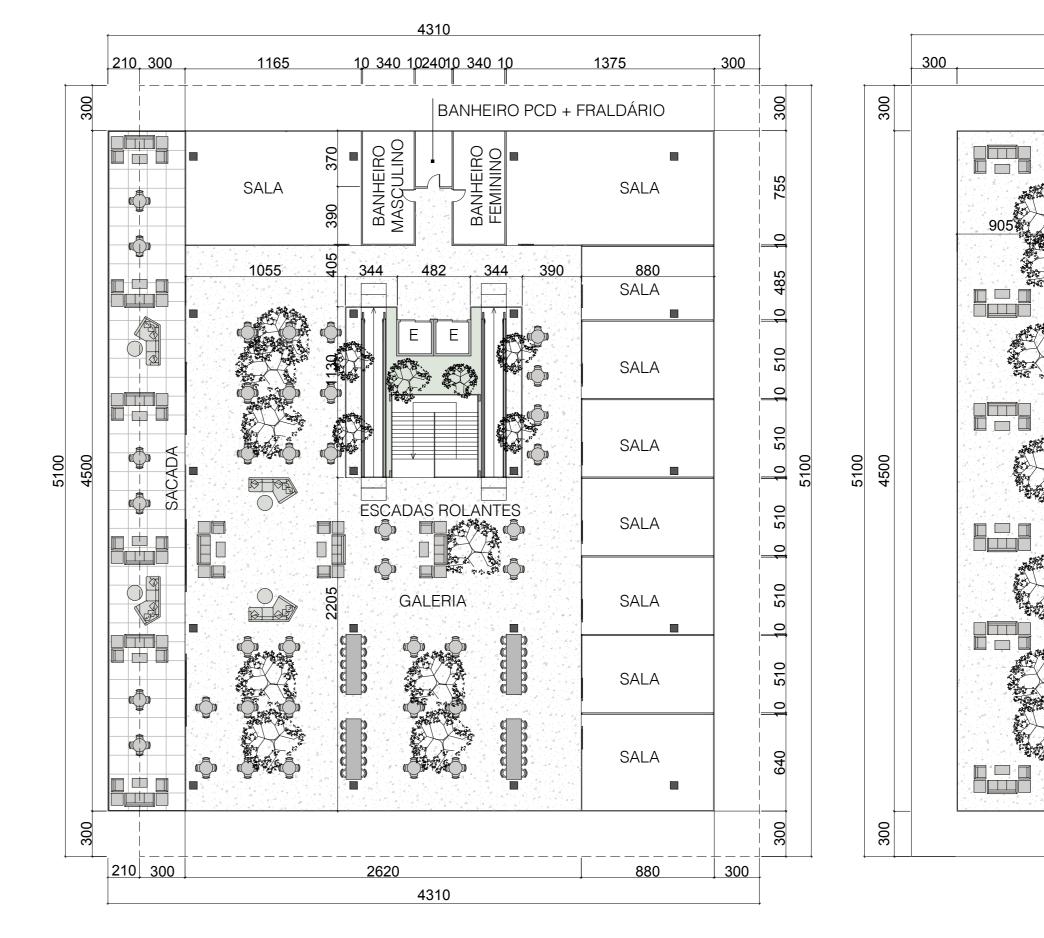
Acesso Pavimento Pilotis Fonte: Autor - 2021
